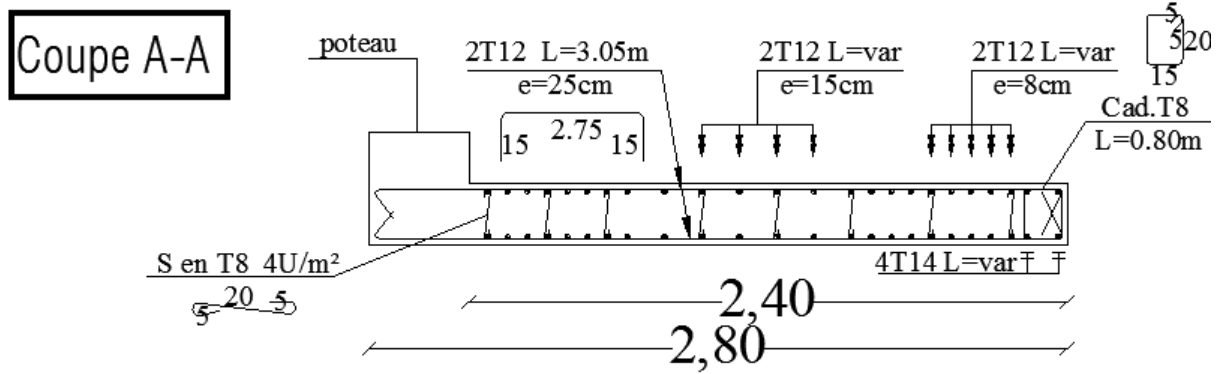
schémas de ferrailages des voiles transversaux.
